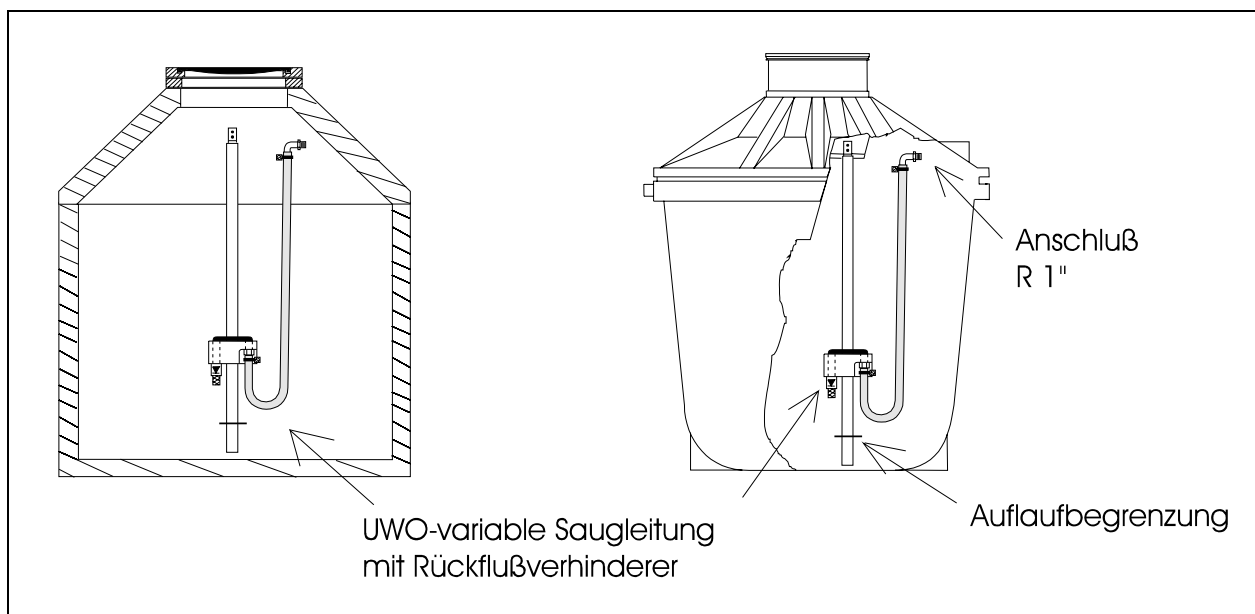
Einbauschema UWO-Variable Saugleitung (VSGL) in Beton- und UWO-Tank
